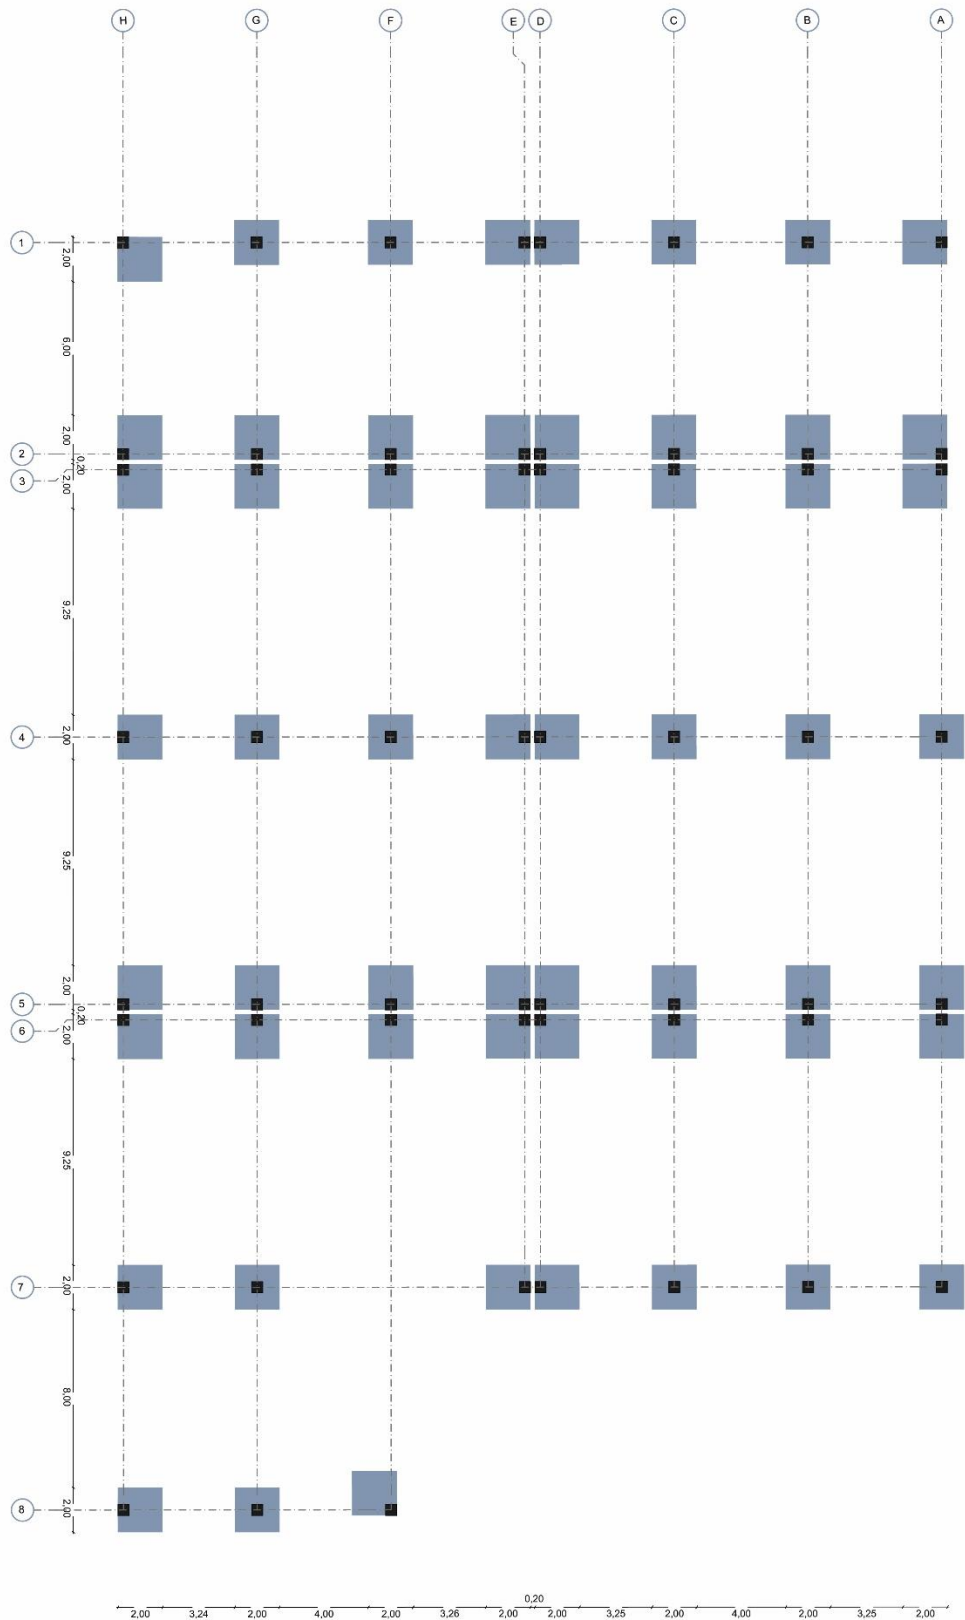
Malla estructural que nos ayuda a la distribución del proyecto.
